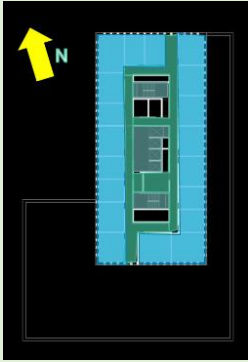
plan 3^{eme} étage de 3^{eme} exemple, www.archiduc.lu
